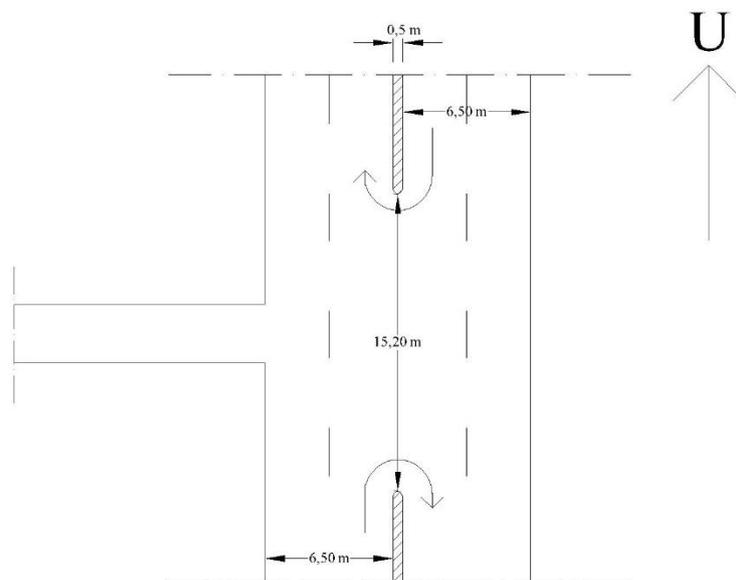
Potongan Tampak Atas Geometri Ruas Jalan Bugisan
